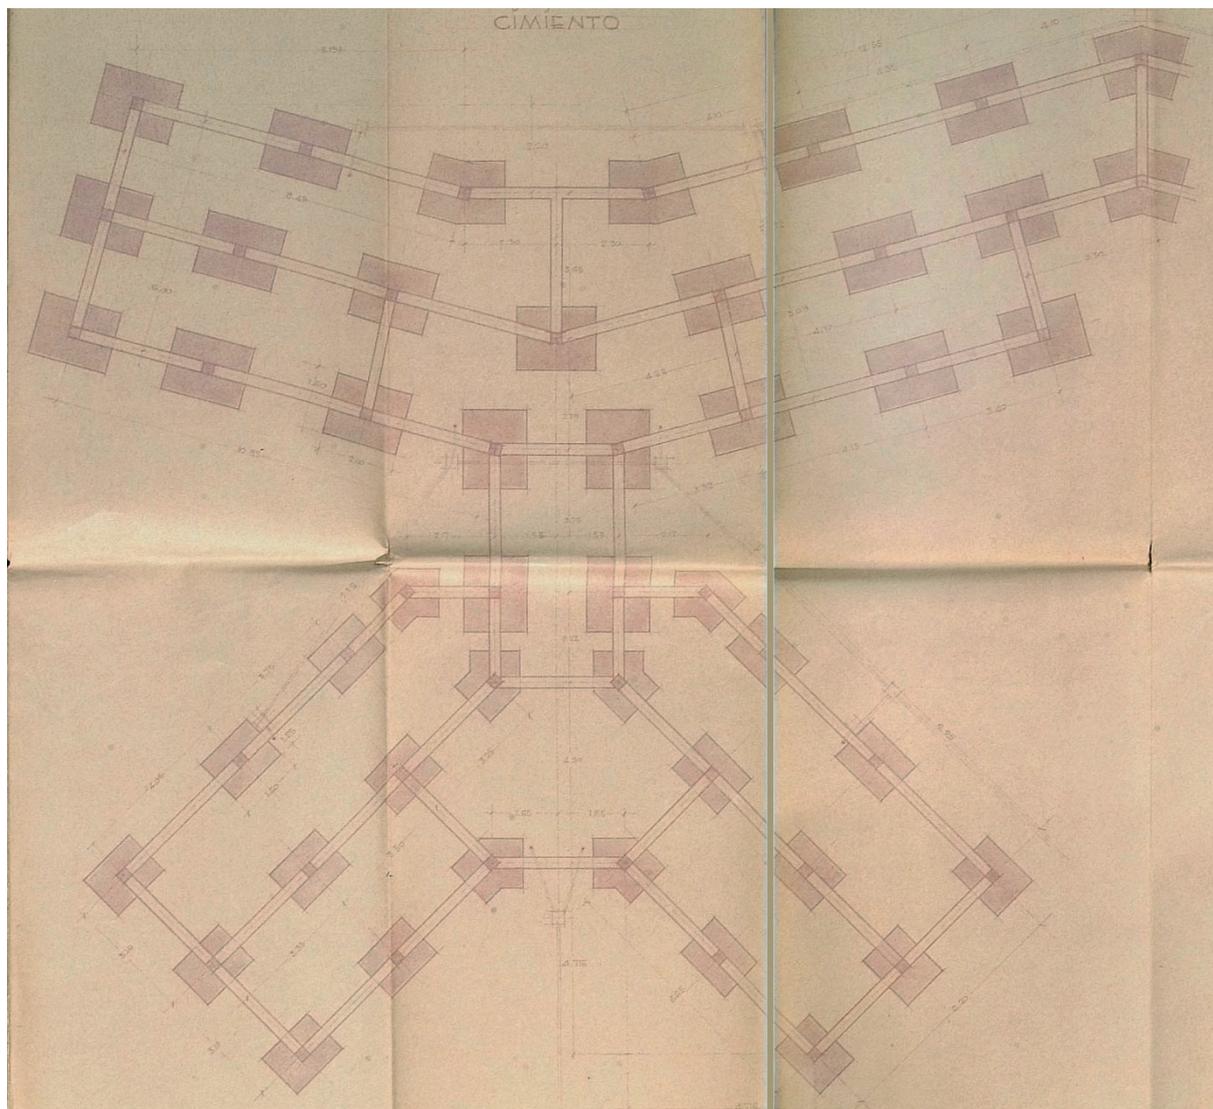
Cimentación bloque en H. ICAS-SAHP, Archivo Municipal de Sevilla, Obras de Particulares
